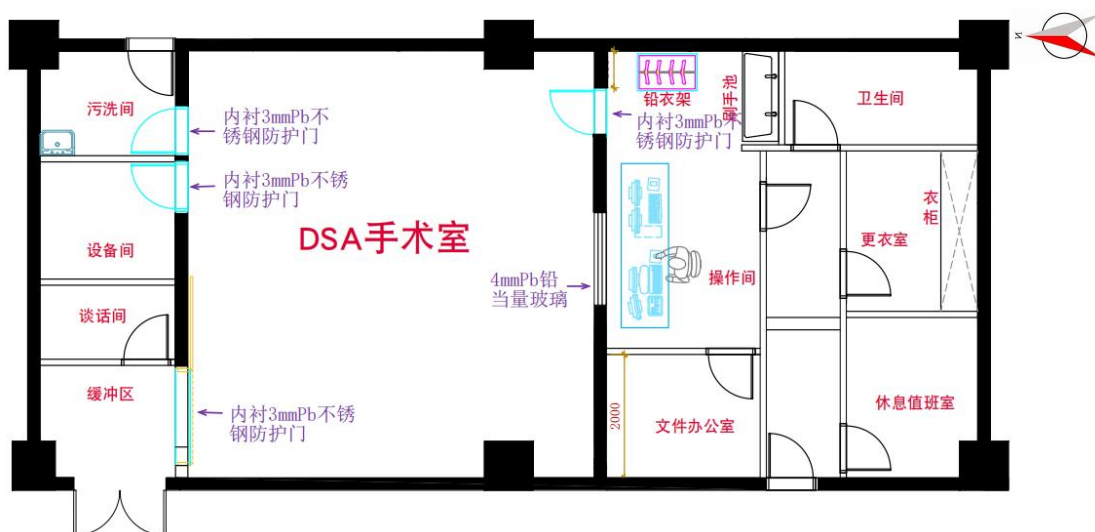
DSA 手术室门、窗屏蔽改造平面布置图
